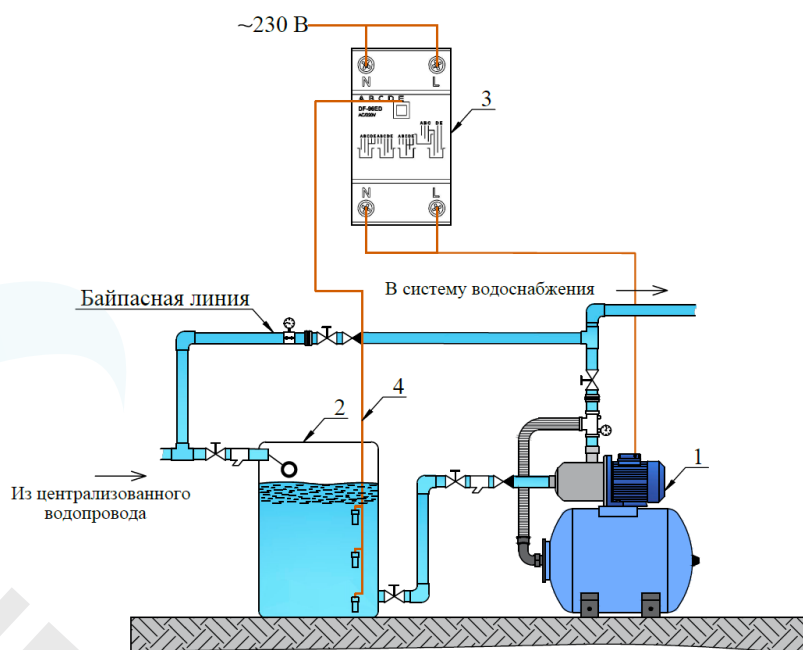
Водоснабжение здания из центрального водопровода
